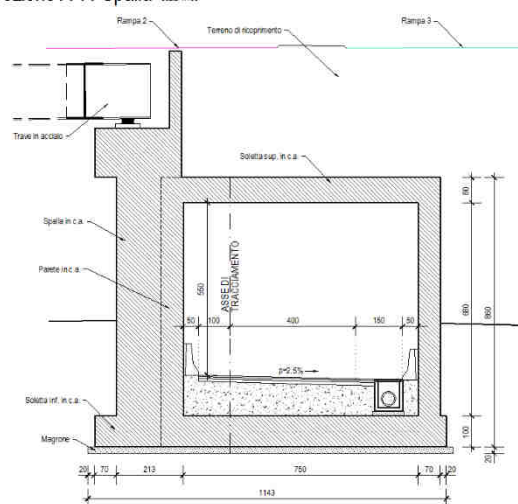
Sezione trasversale in corrispondenza dell'attraversamento delle rampe 2 e 3
